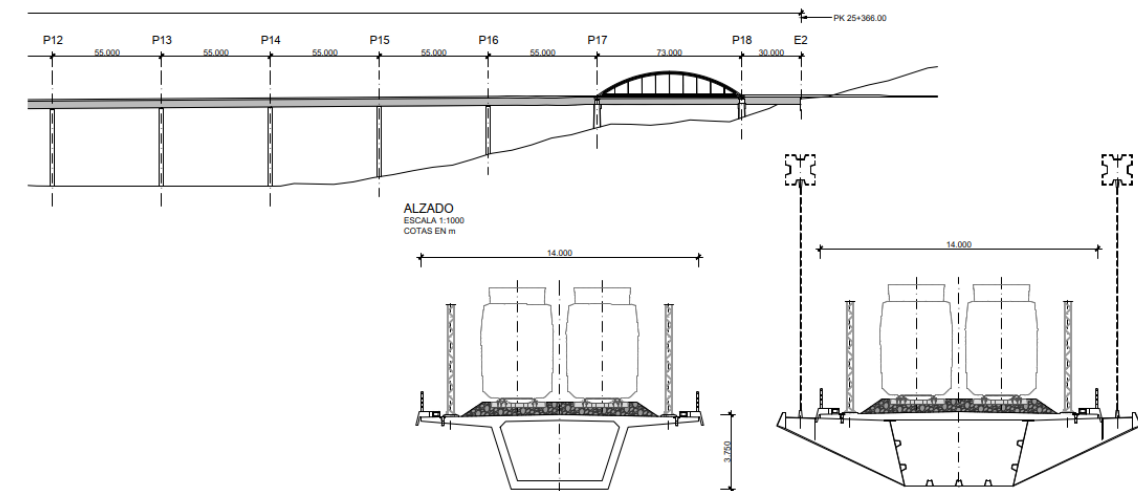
Viaducto Praves / A8 (Alternativa A1)
